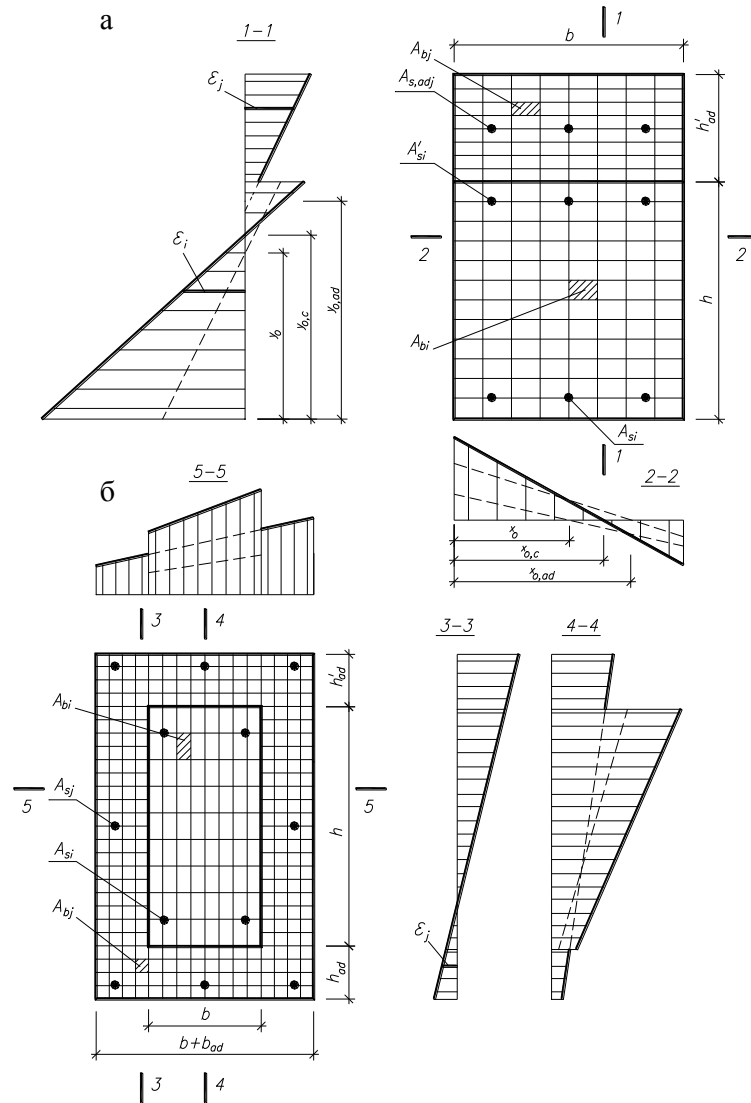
Расчетная схема железобетонного элемента с усиленной сжатой зоной.
